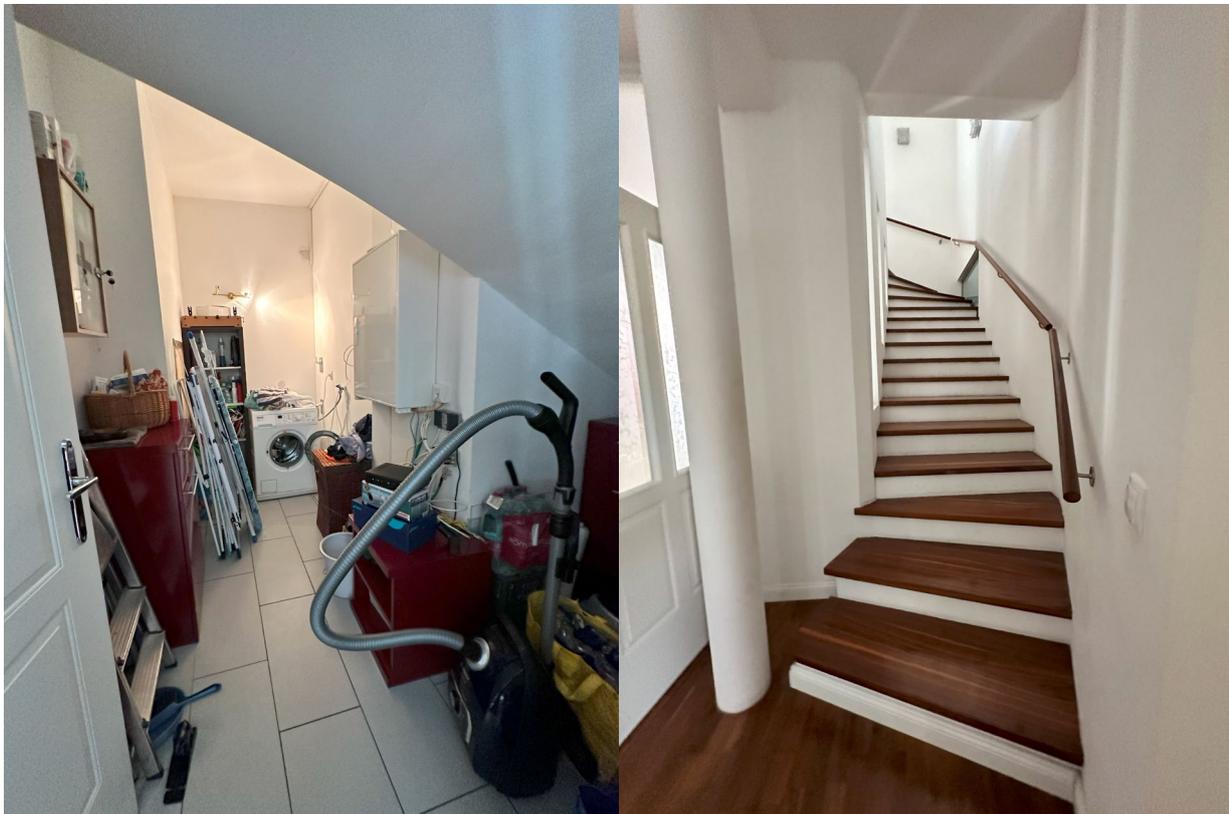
+ 20: Abstellraum EG unter Stiegenaufgang
